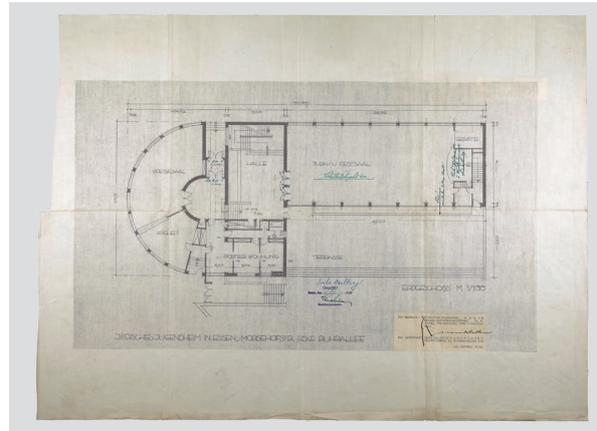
Jüdisches Jugendheim in Essen, Grundriss Erdgeschoss, Genehmigungsplanung, datiert 20.10.1930.
